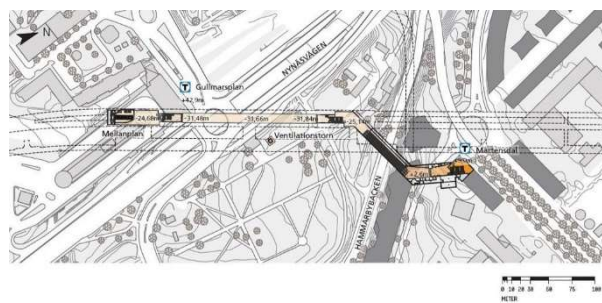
Planta y alzado de la estación. Imagen: TYPESA/Sweco.
